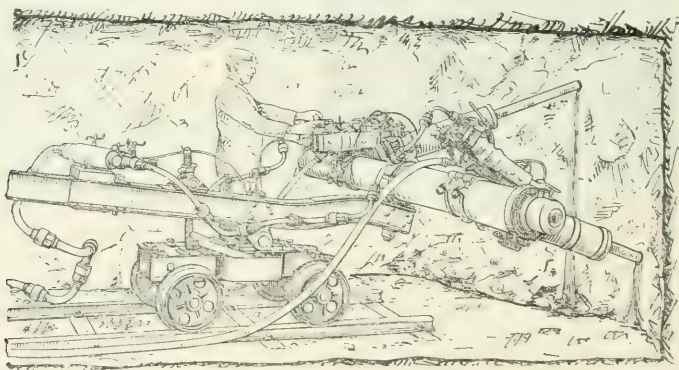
Bohrwagen mit Brandtscher Maschine.
